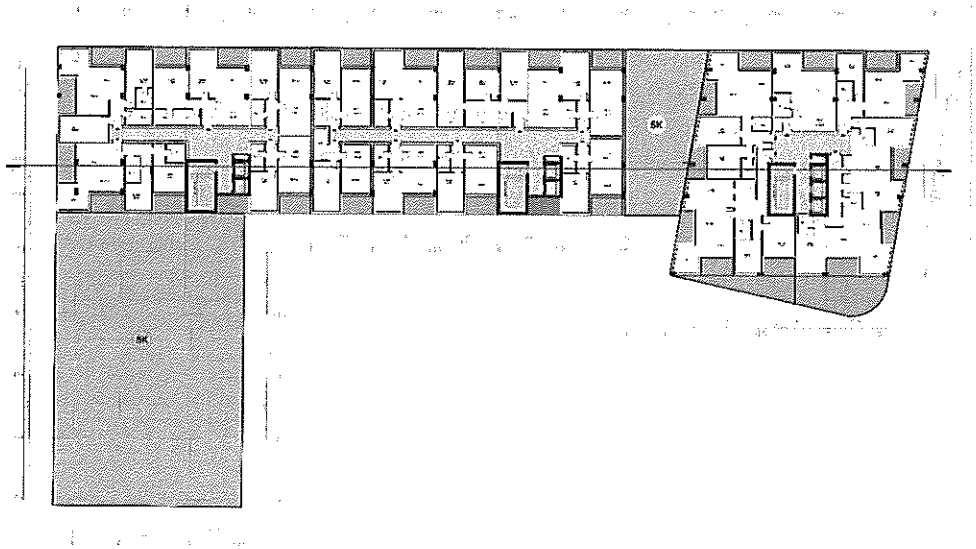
Planimetria në Kuotën +22.75 deri +40.25
